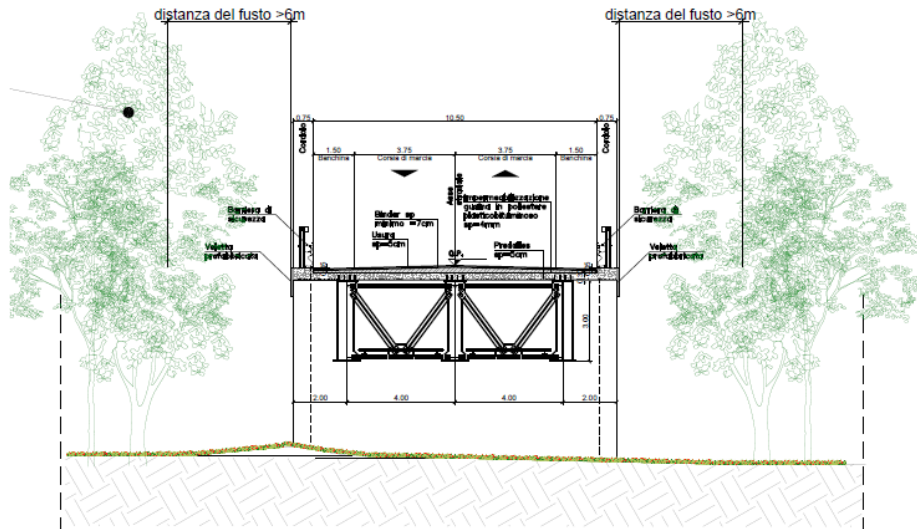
vista in sezione del tracciato, viadotto VI01
